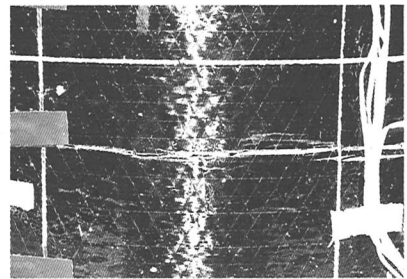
橋脚基礎に生じたCFSのひび割れ
